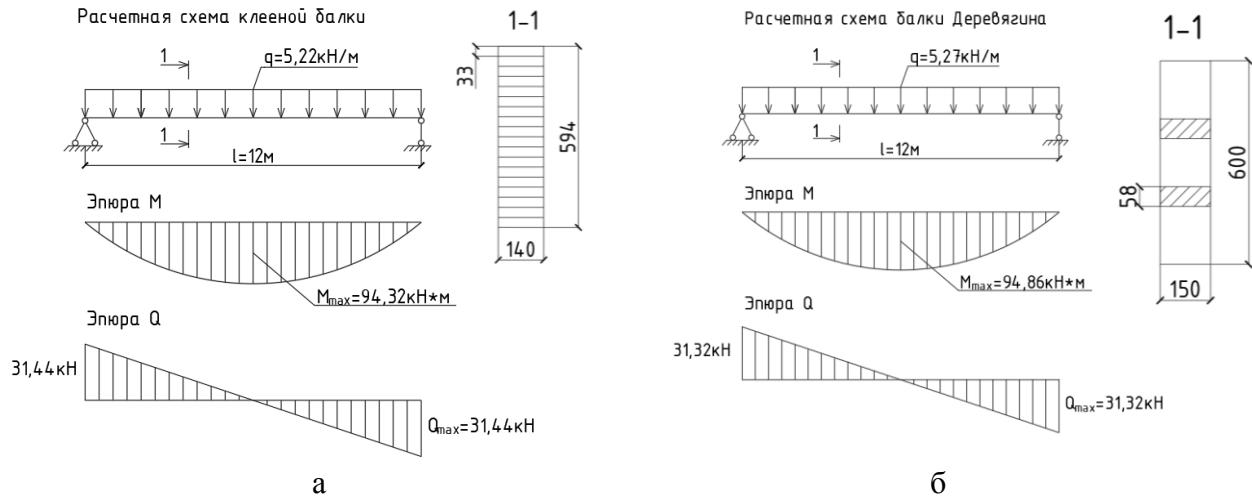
Расчетные схемы балок: а – клееная балка; б – балка Деревягина
